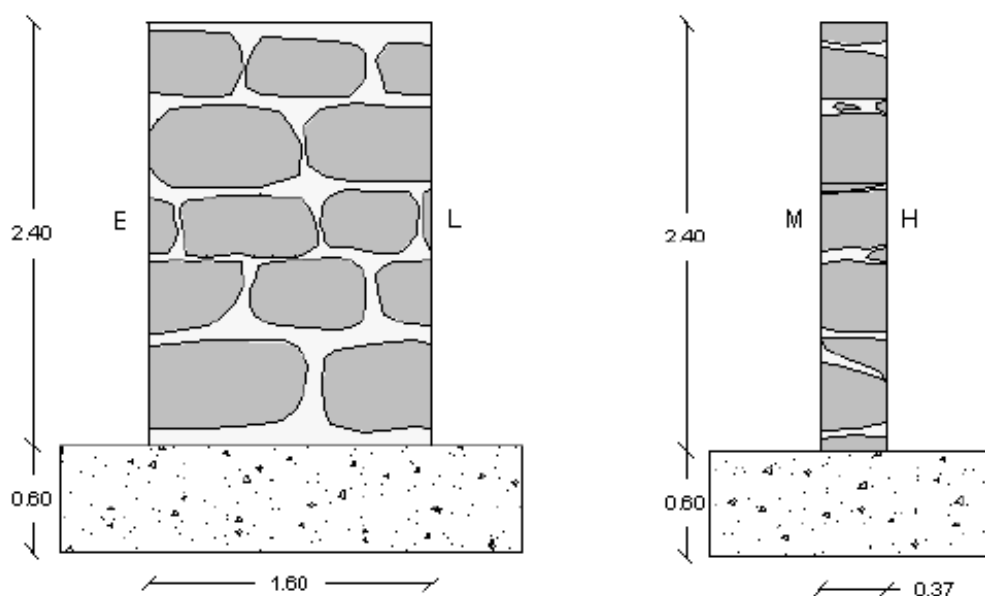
Alçados parede de alvenaria P1 estudada em laboratório.
